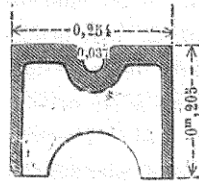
Système de MM. Ransome, Deas et Rapier. Section du rail; 101 kil. par mètre courant. Échelle 1/12.
